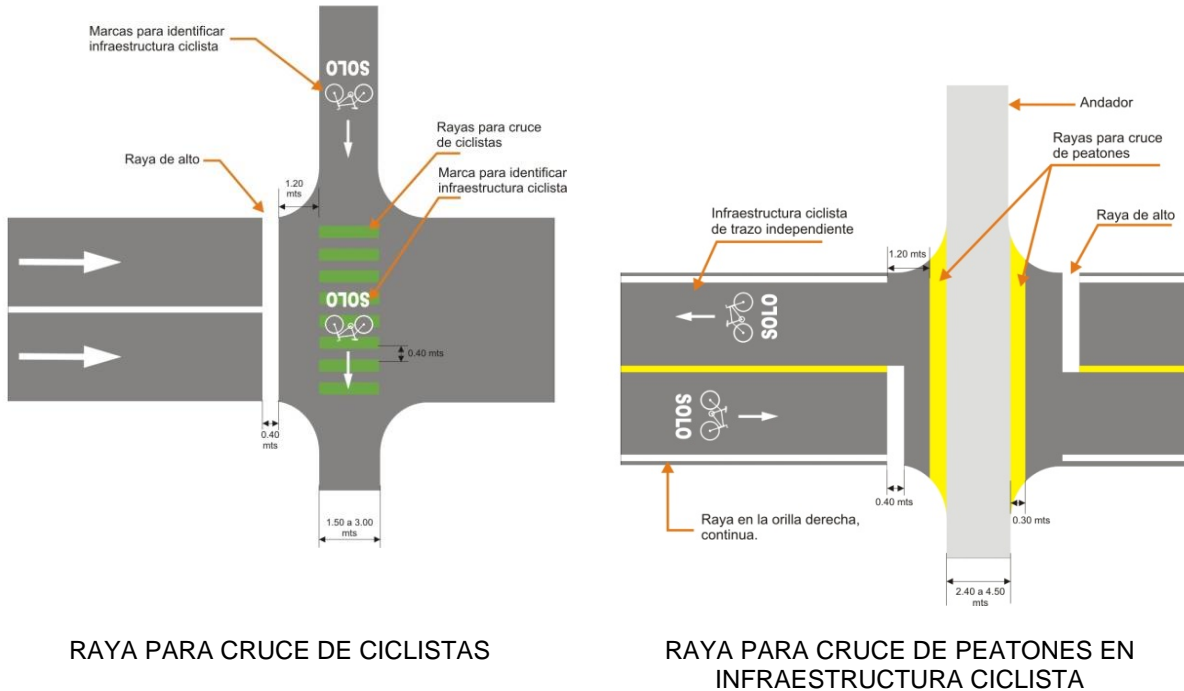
Señalización horizontal en pavimento de Infraestructura Ciclista
